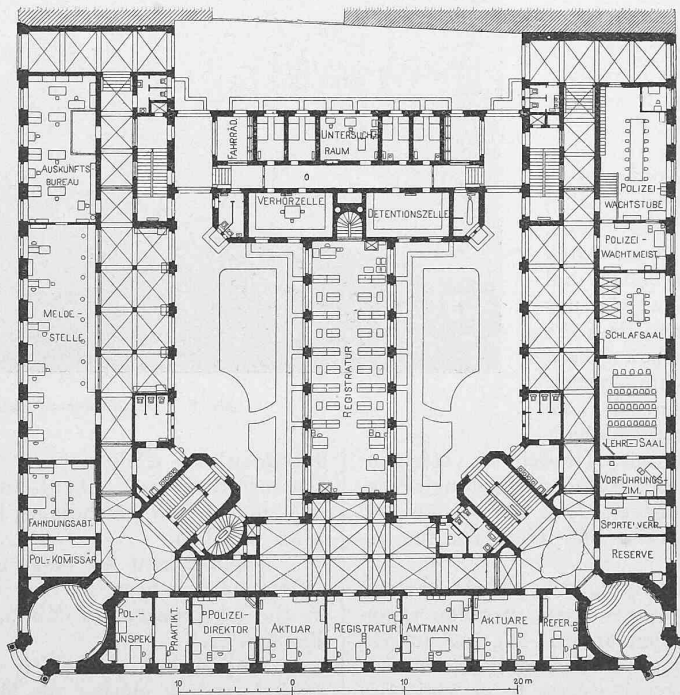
Grundriss vom Erdgeschoss. — Masstab 1 : 600.
